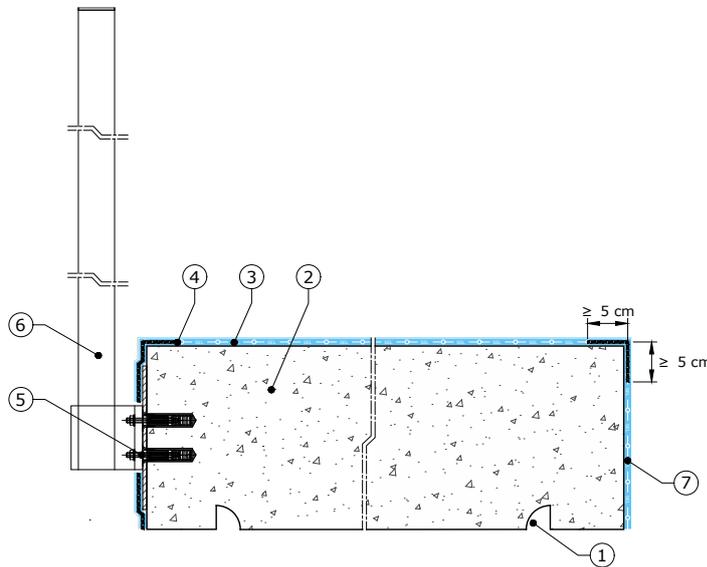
Coupe sur escalier préfabriqué sans mur d'échiffre - Exemple
